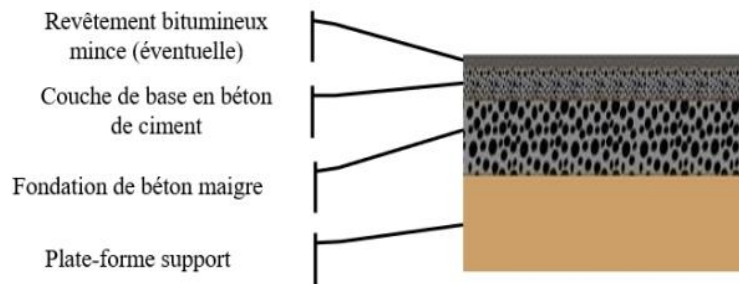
Structure d'une chaussée rigide (Nguyen, 2008).
